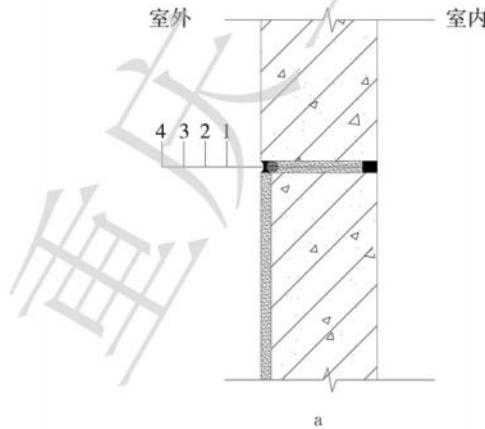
内嵌围护外墙水平接缝防水构造示意图
